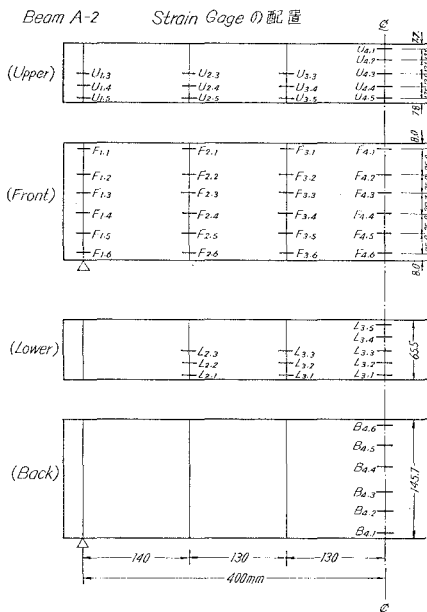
鋼箱桁模型 Beam A-2 のゲージの位置
